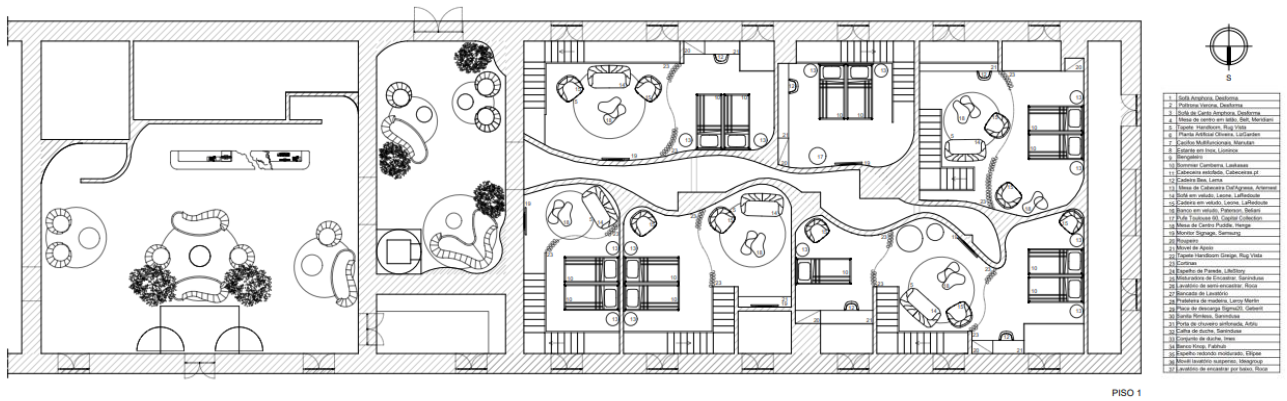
Planta de Mobiliário e Equipamento, Piso 1, Alojamento Olive
